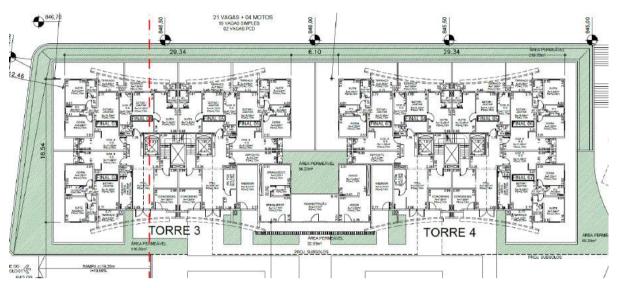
Projeto - Pavimento Térreo - Torres 3 e 4.
